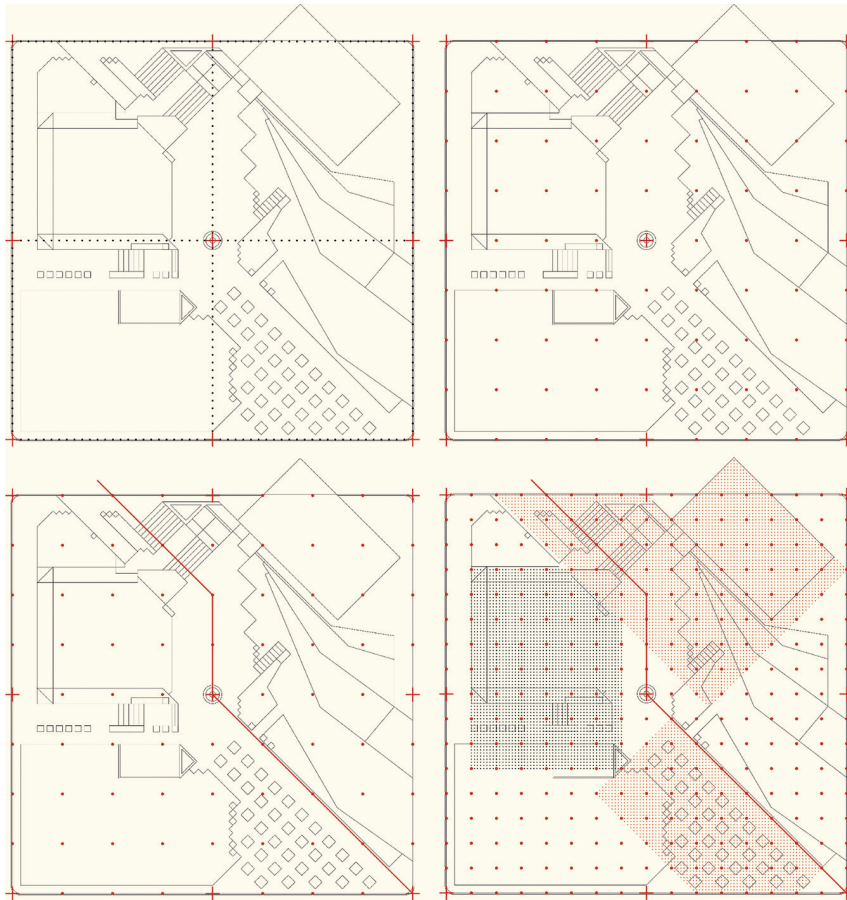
Dibujo sobre la planta arquitectónica del parque de Curridabat.
